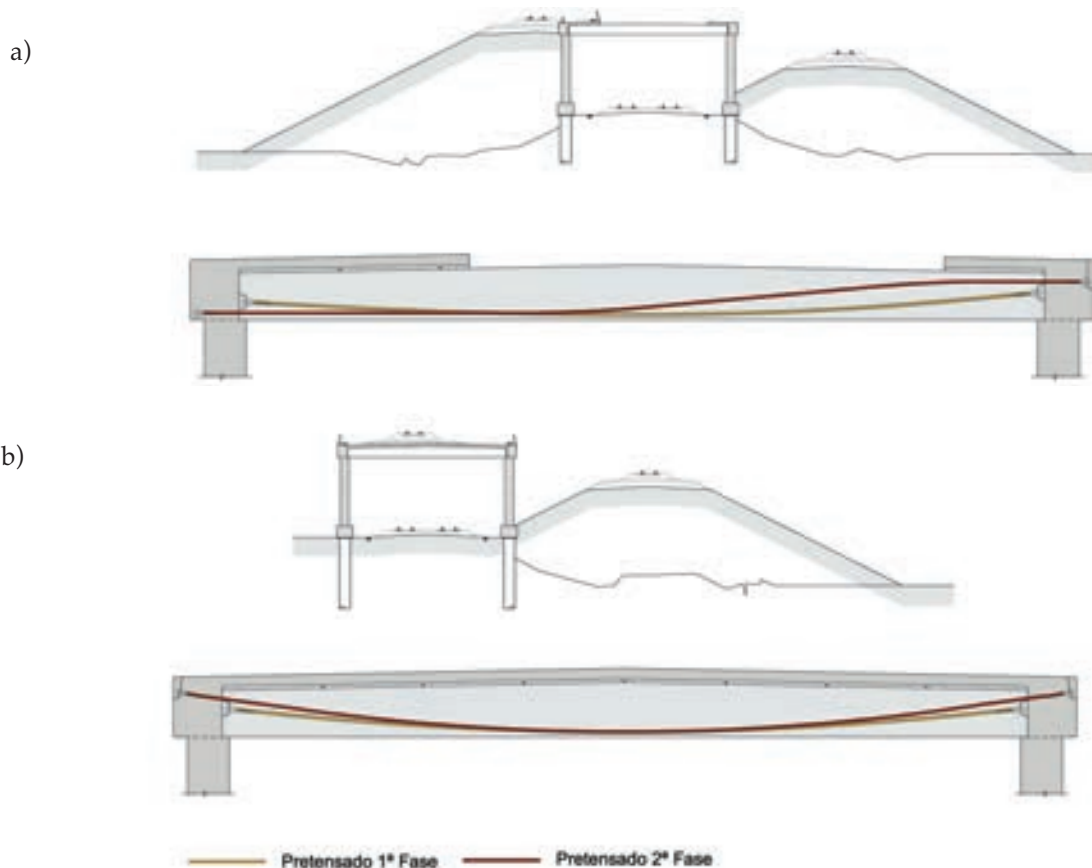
Secciones transversales y pretensado de las vigas de la pérgola en la L.A.V. Madrid-Toledo en Alameda de la Sagra; a) Zonas extremas; b) Zona central
